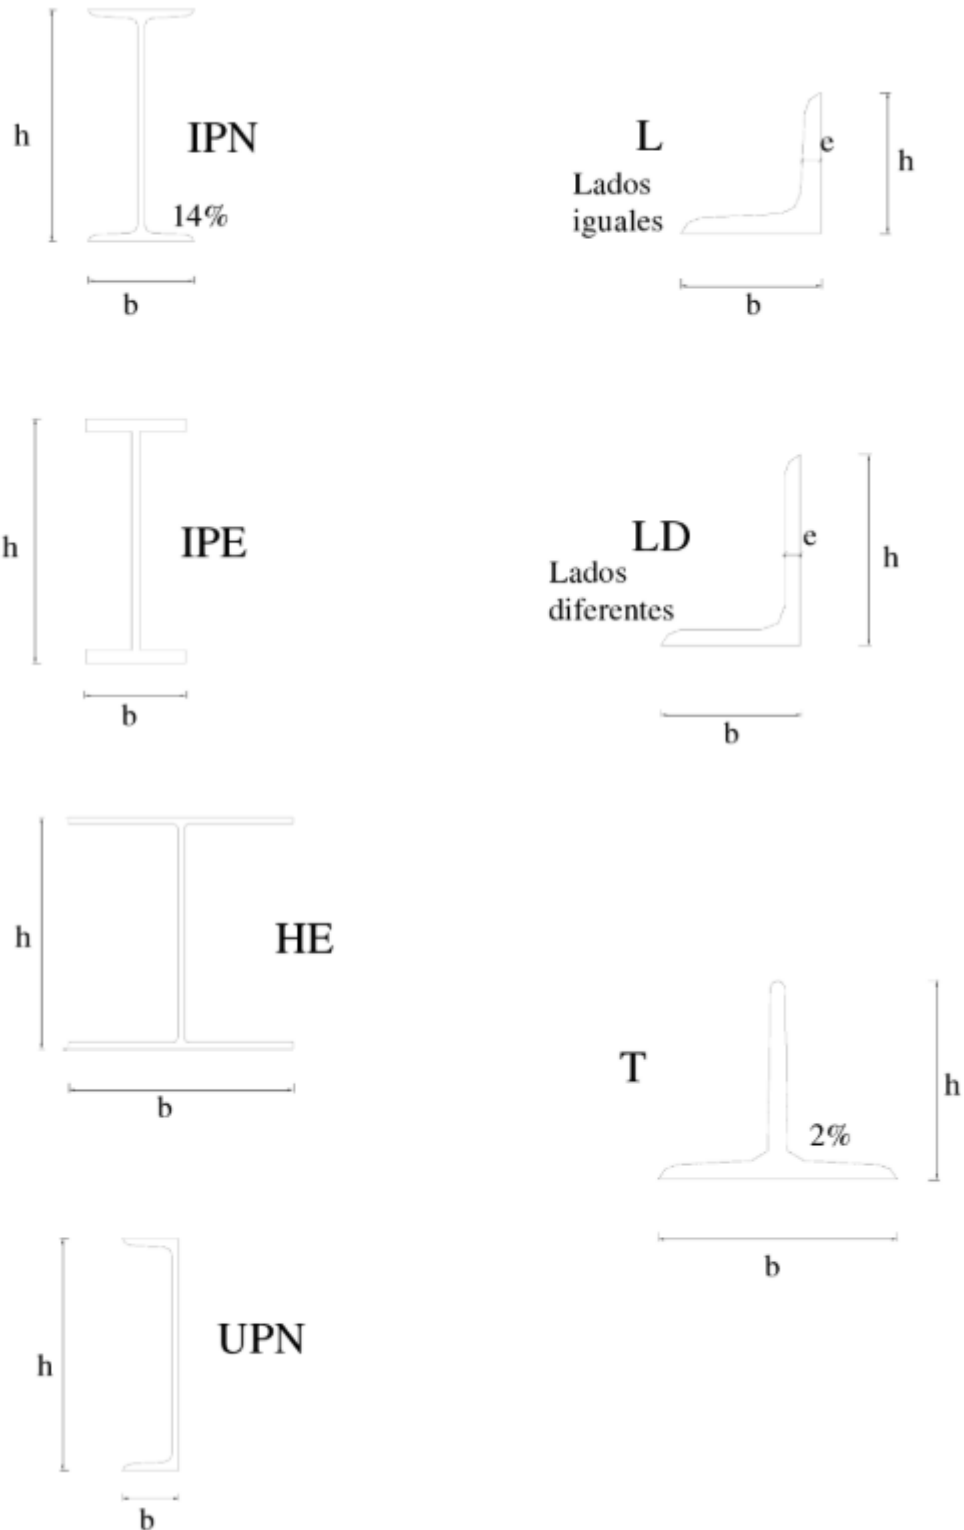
Perfiles de acero más conocidos y utilizados en estructuras metálicas
